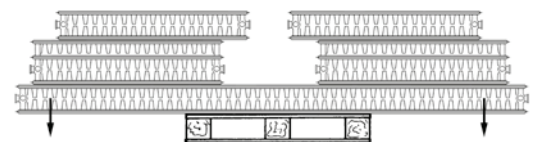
Falsche Lagerung führt zu Beschädigungen
